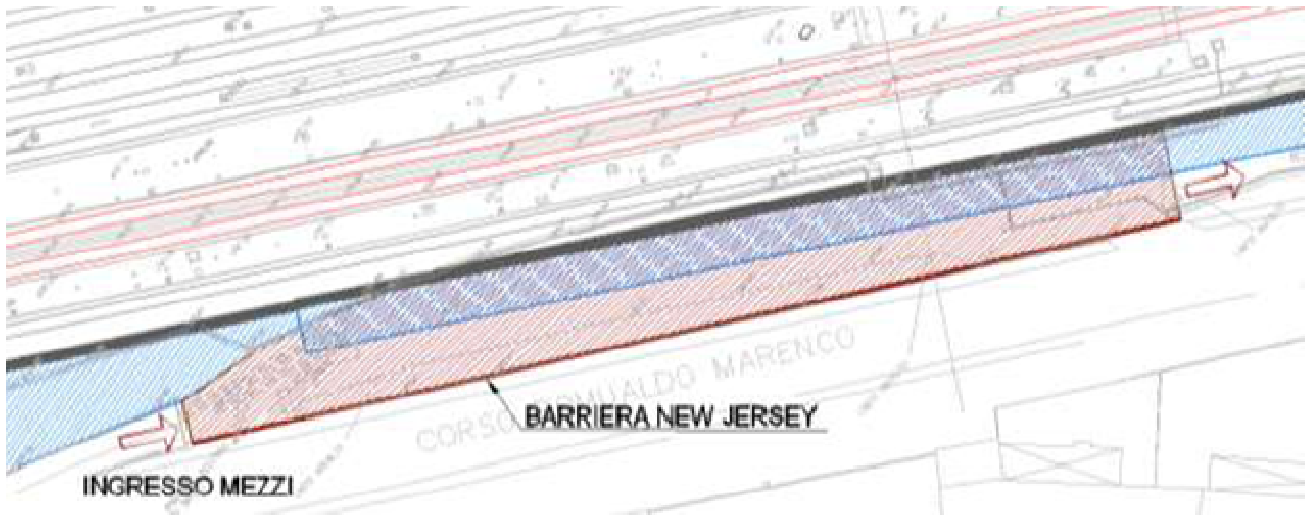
Stralcio planimetrico Area Cantiere – Ingresso mezzi
